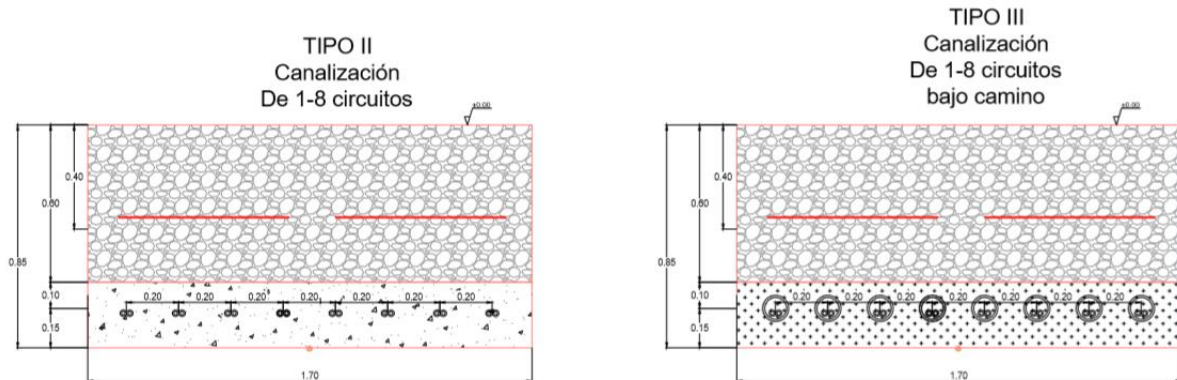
Detalle de zanjas para circuitos de Baja Tensión (izqda.) y de zanjas bajo camino (dcha.)
